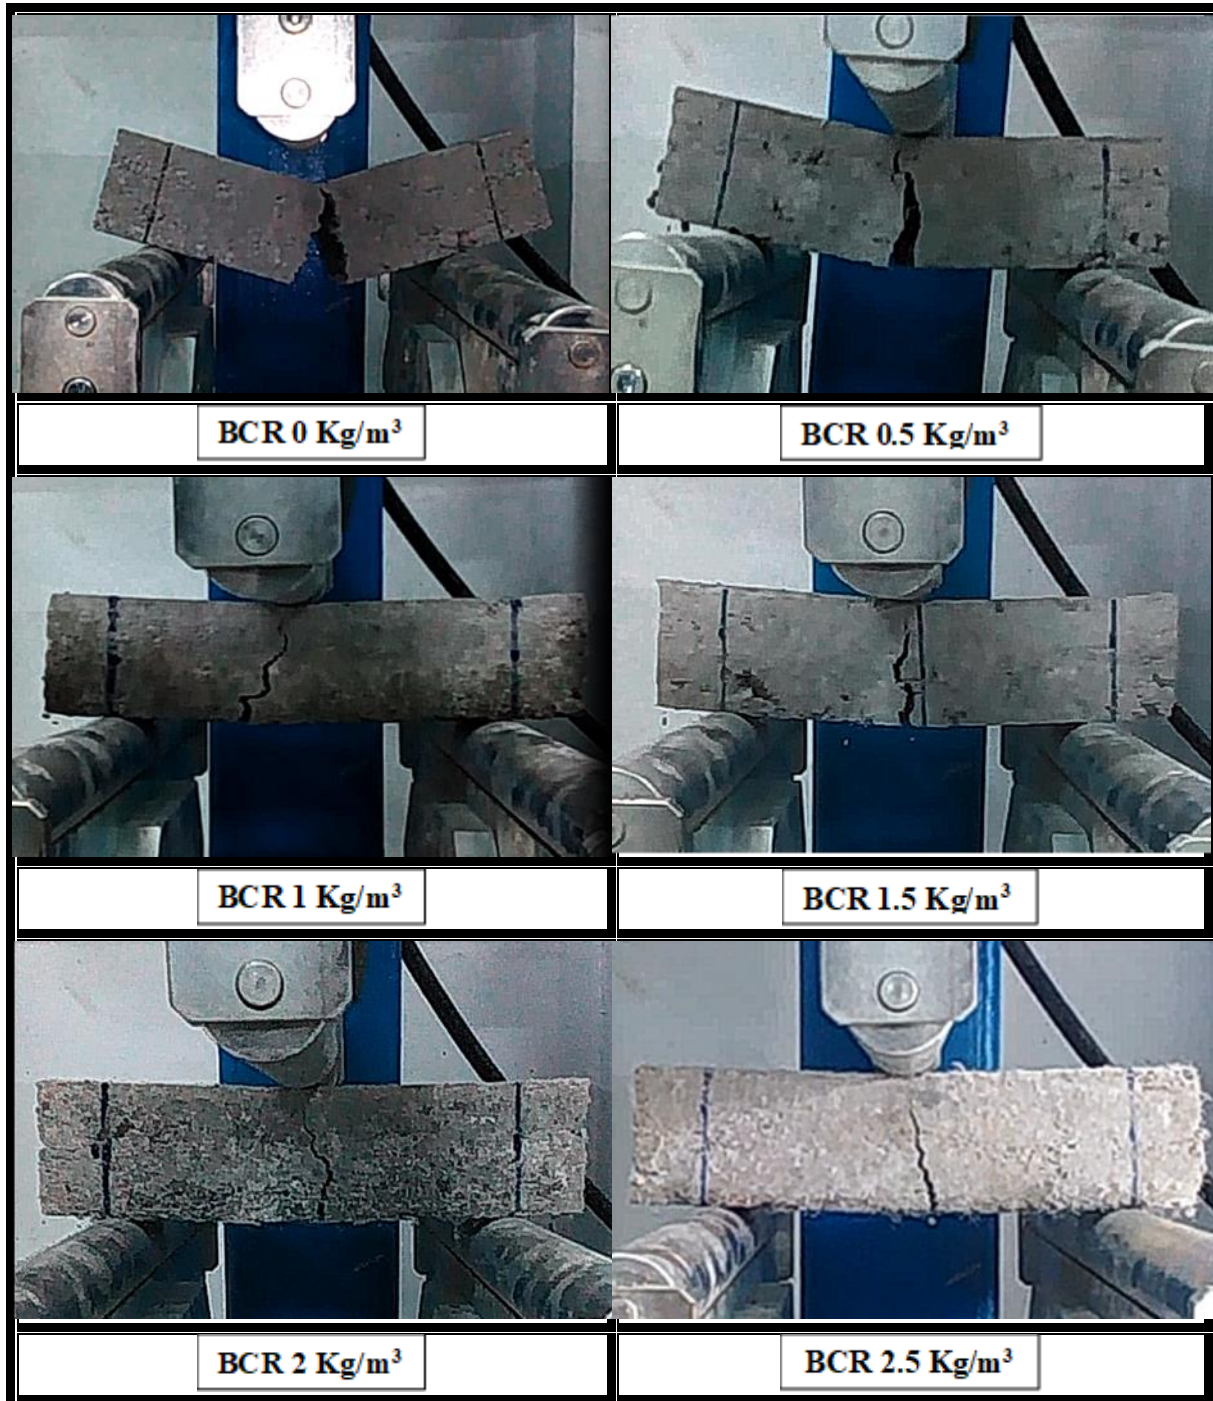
Aspect des éprouvettes à la rupture.
